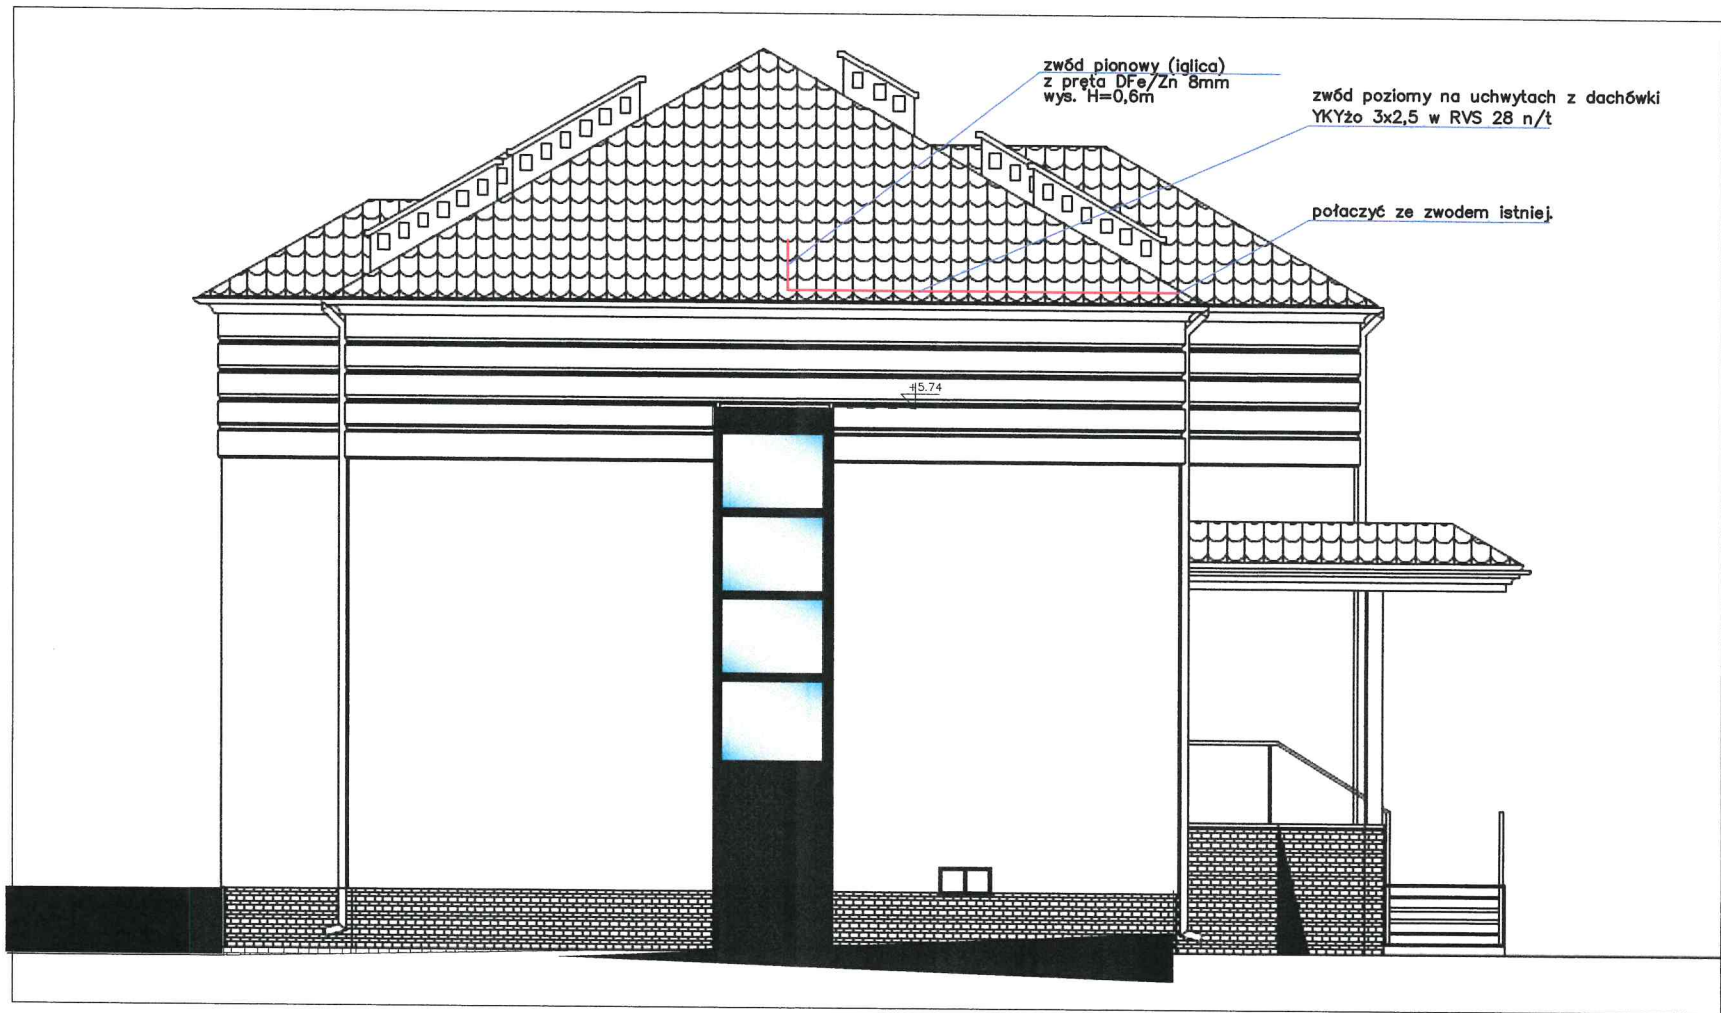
Elewacja boczna – instalacja odgromowa - widok
